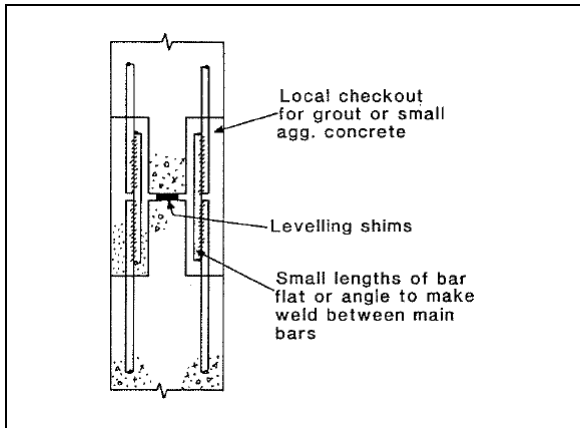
Ligação por chapa/varão de aço sobreposto soldado (Elliott, 1996)
